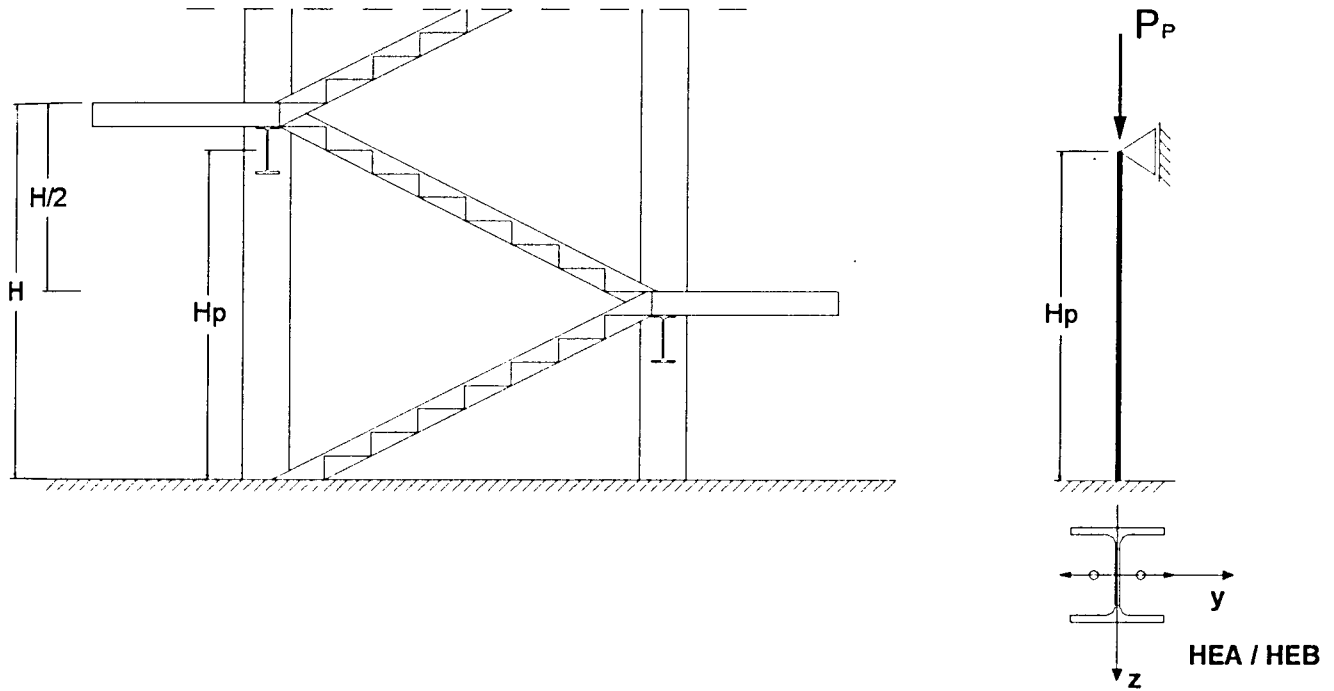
ESQUEMA ESTRUTURAL PARA DIMENSIONAMENTO DO PILAR
